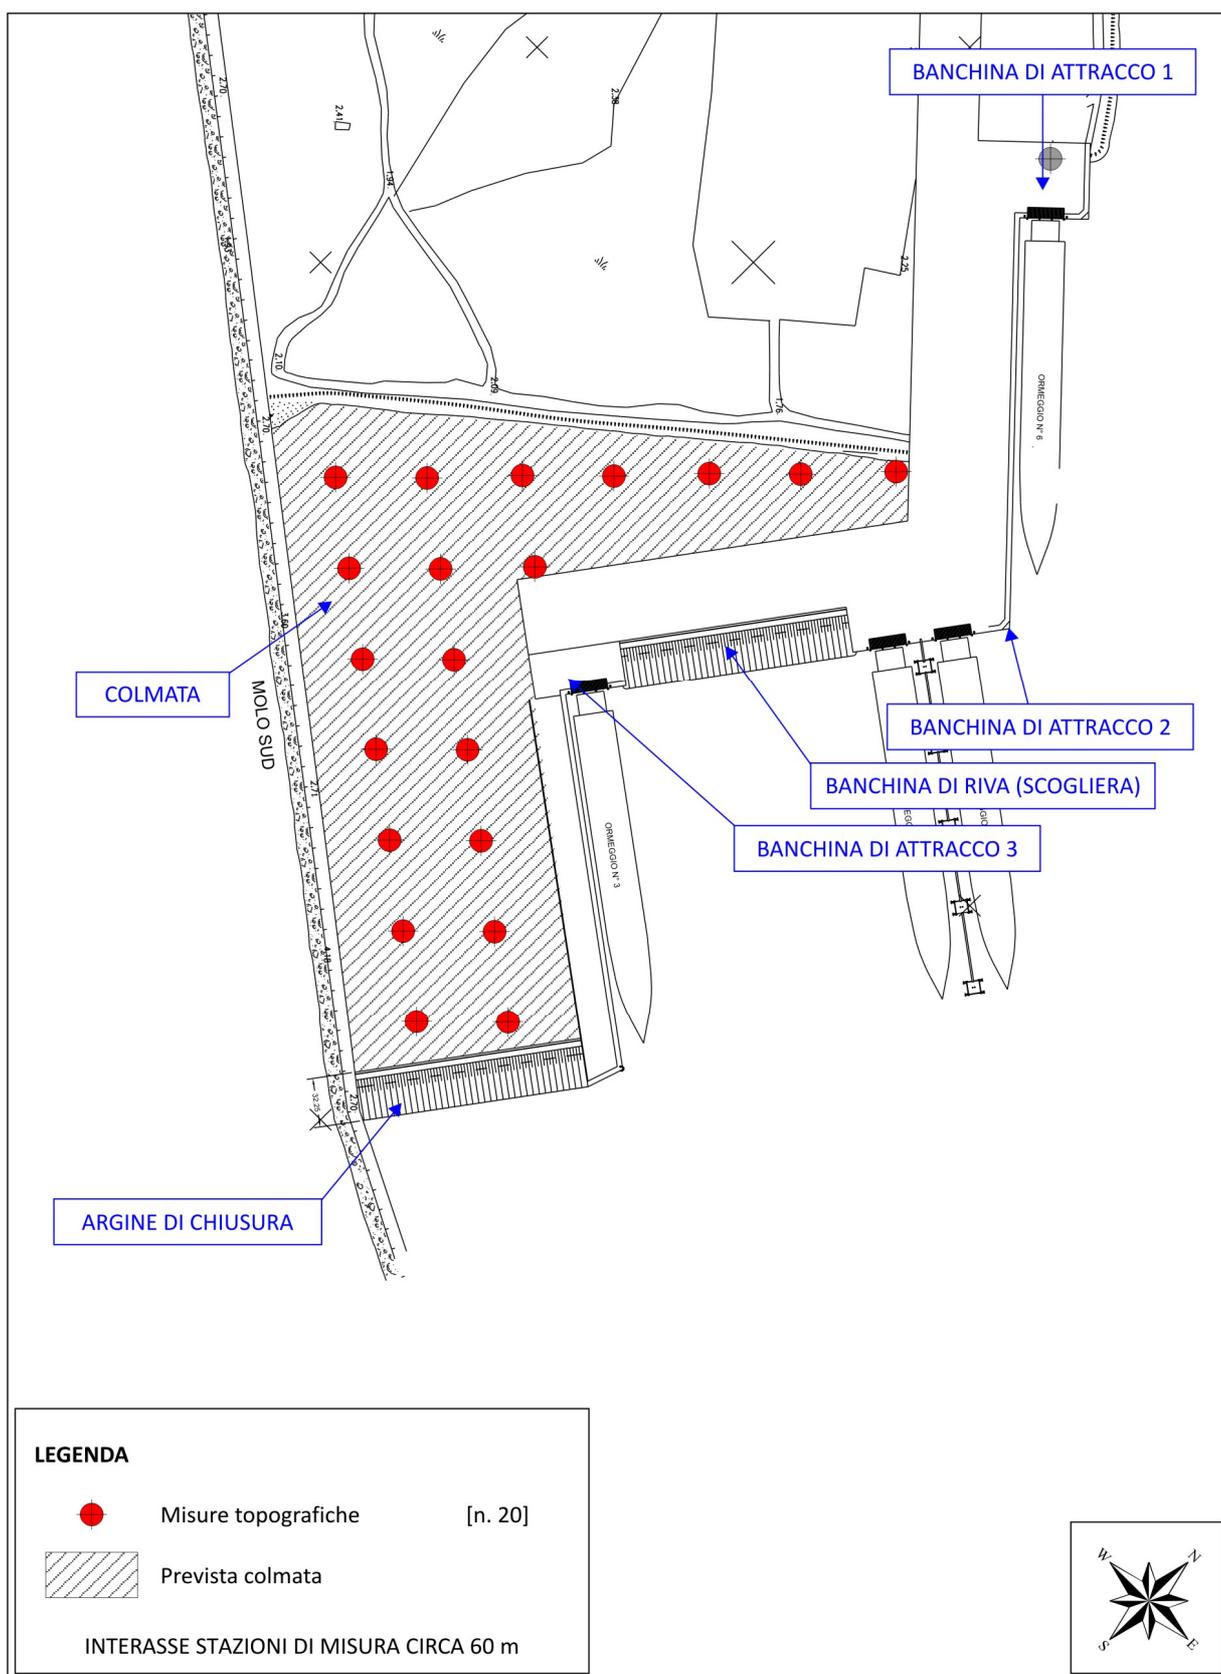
Distribuzione planimetrica delle stazioni di misura topografiche
